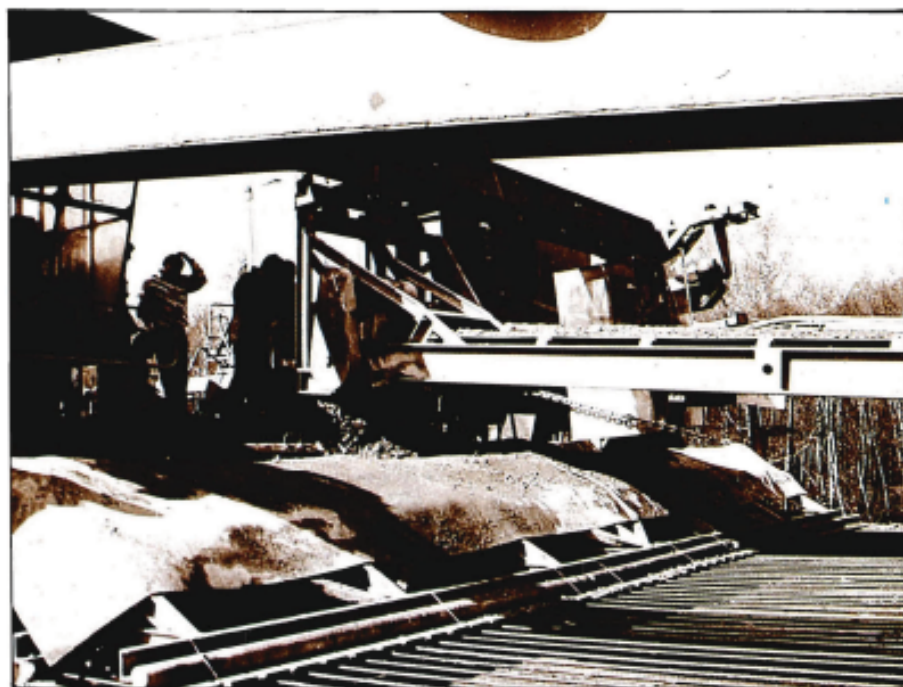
Guías para posicionado de las armaduras en un pavimento de hormigón armado continuo (autopista A71, Francia)
